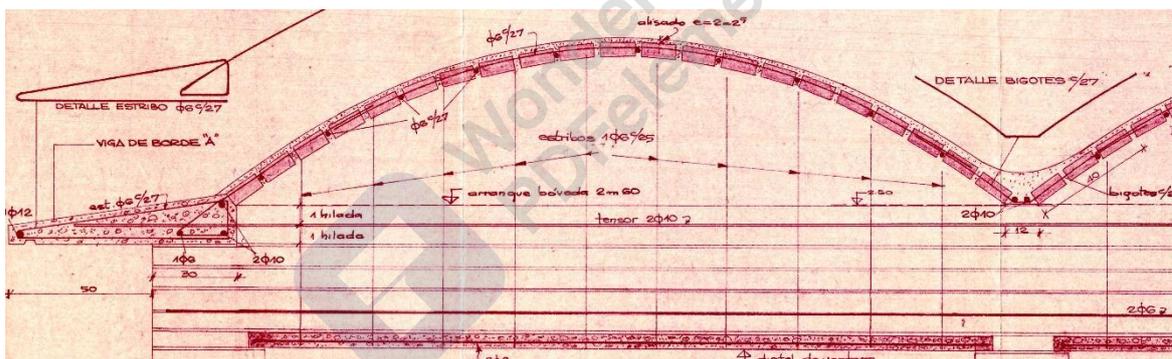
Corte parcial de cubierta original (extraído de Plano 9, CEPN, s/fecha).
